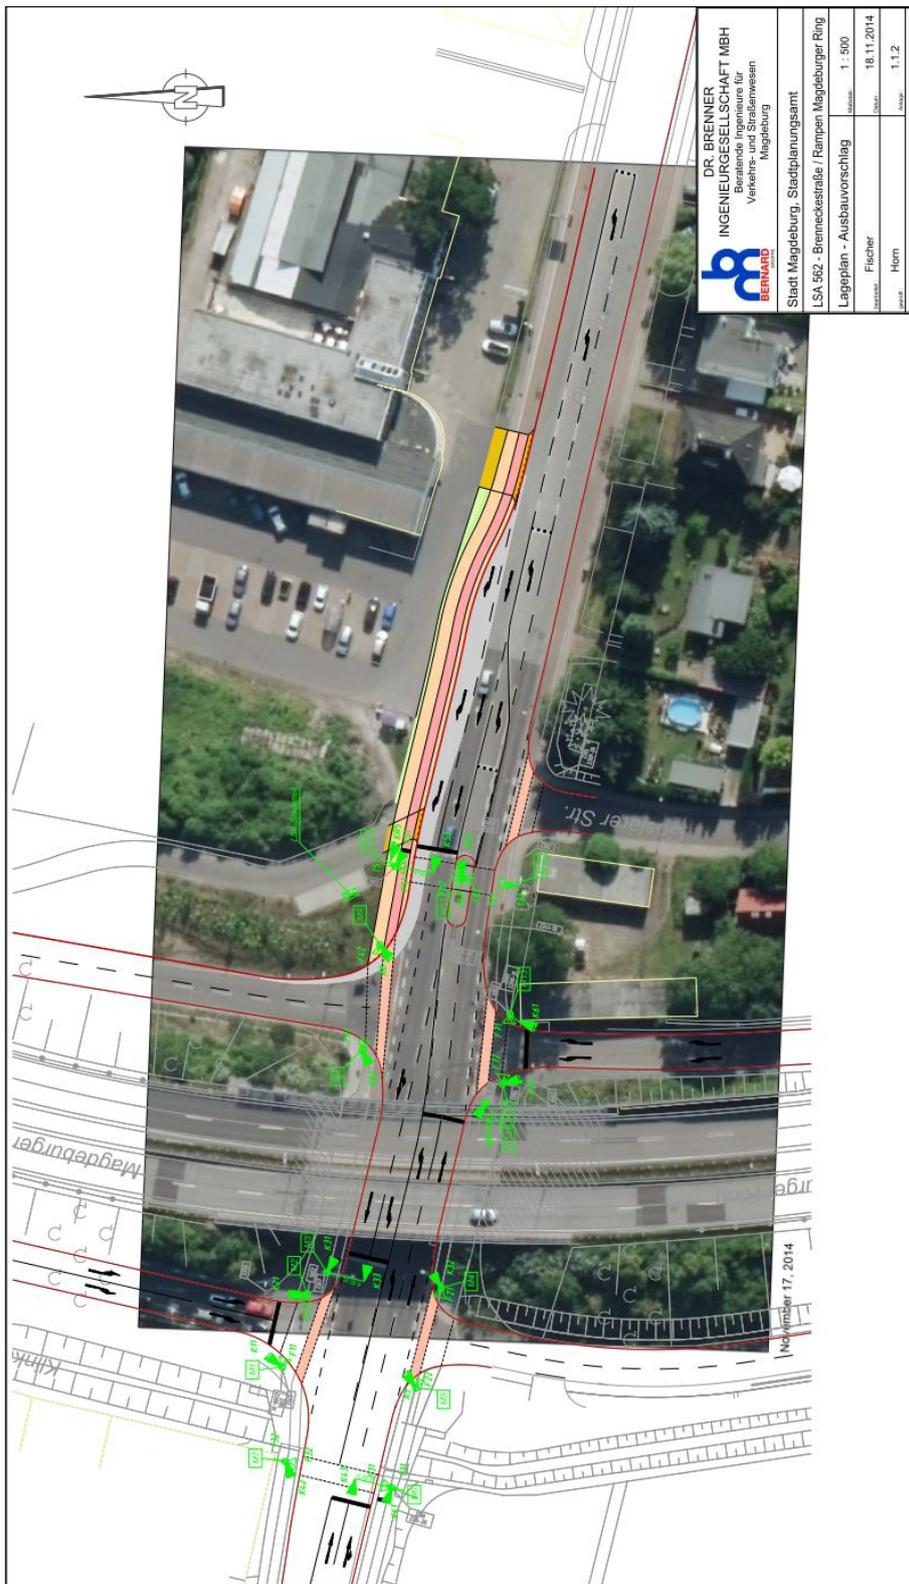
Lageplan Ausbauvorschlag für die Ostzufahrt der Brenneckestraße am Knotenpunkt Magdeburger Ring, Dr. Brenner Ing.-ges. Nov. 2014
